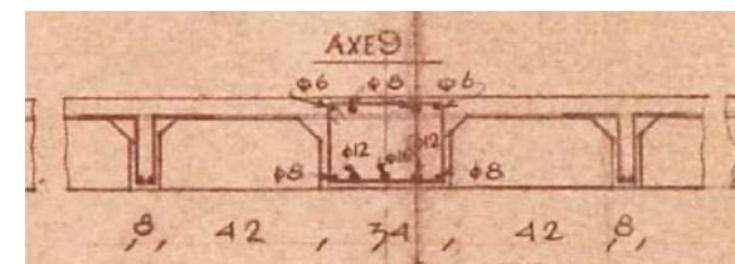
SECCIÓN DEL FORJADO UNIDIRECCIONAL
